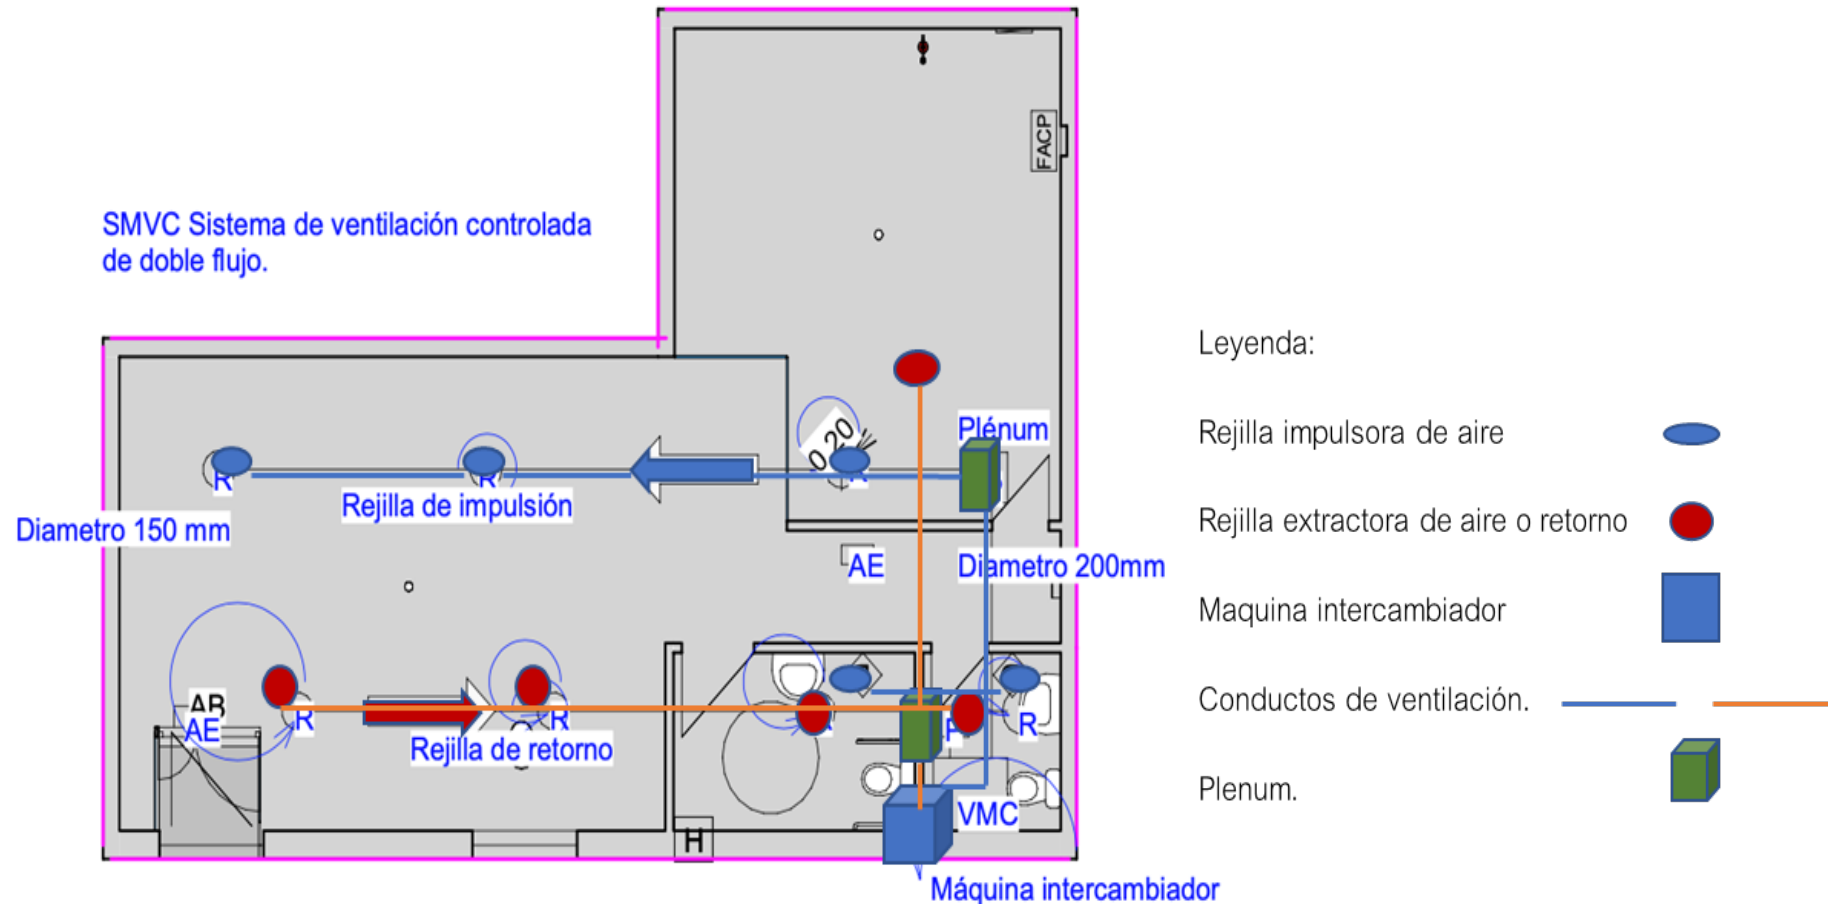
Plano reformado e instalación de ventilación. Fuente: Propia
